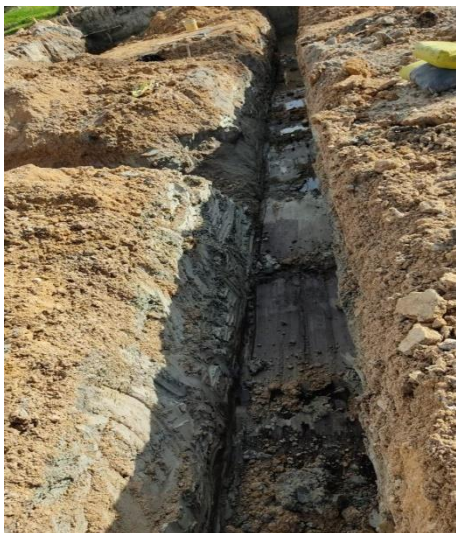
Excavación vigas de cimentación, fuente: Cifuentes M
